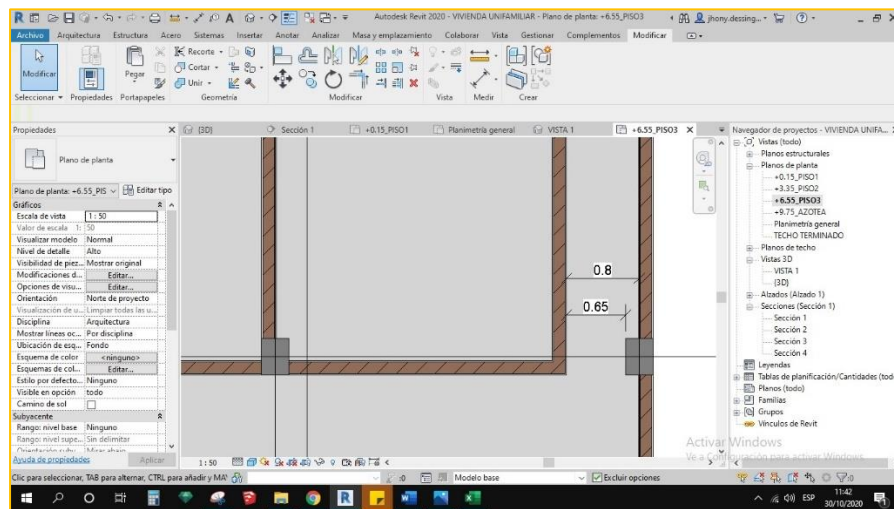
Acotación de pasadizo en modelo de Revit arquitectura.
